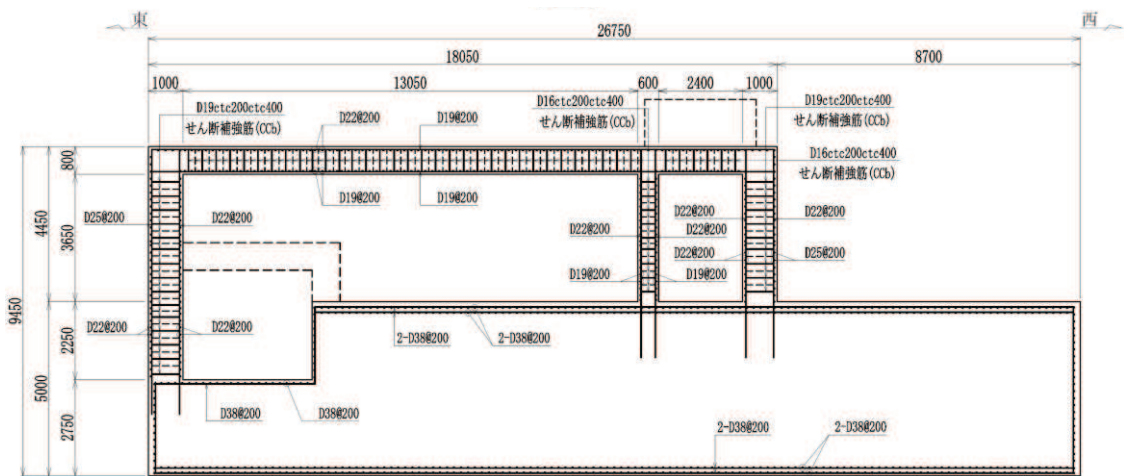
(4) 復水貯蔵タンク基礎 概略配筋図 (3-3 断面)
